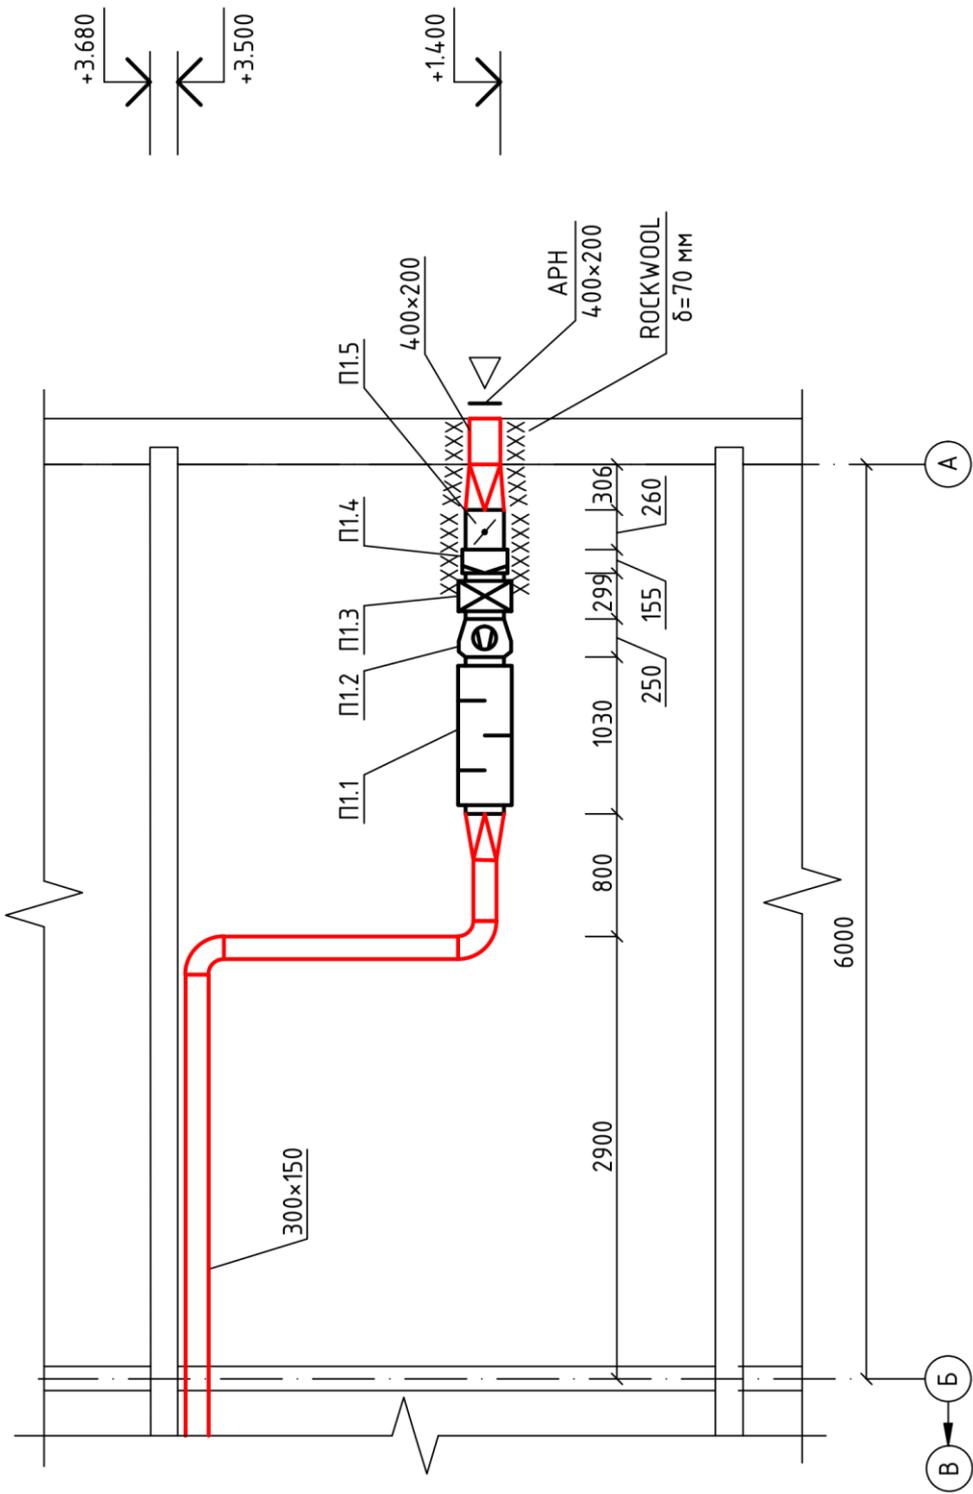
Пример чертежа приточной установки (разрез)
